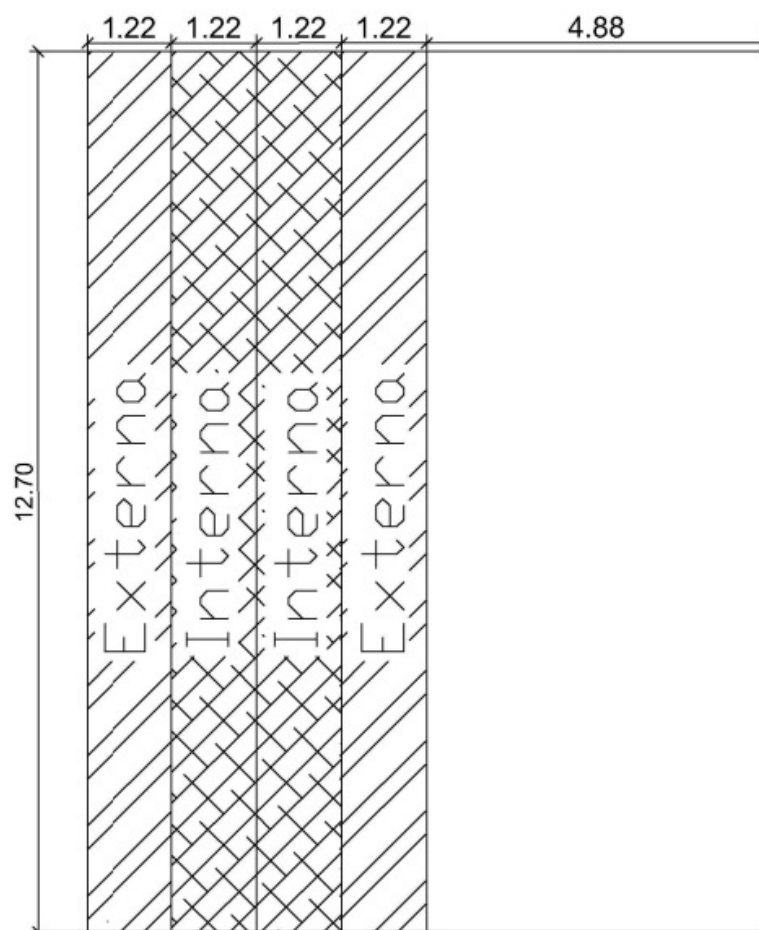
Divisão de Faixas Internas e Externas no Pórtico 1
